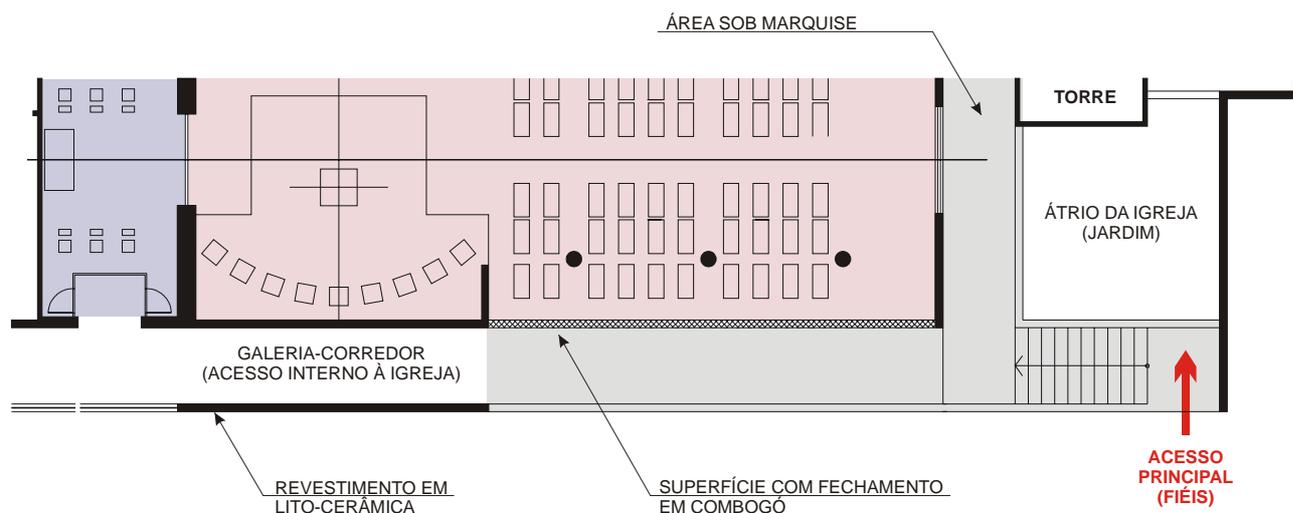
Trecho pavimento térreo – detalhe da fachada das igrejas. (Desenho da autora, a partir de plantas do acervo do MNSG).
